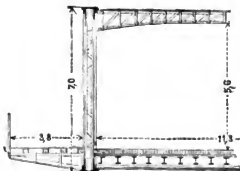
Fahrbahn von Straßenbrücken mit Fachwerksträgern. Tiefe Konstruktion. M. 1 : 200.
